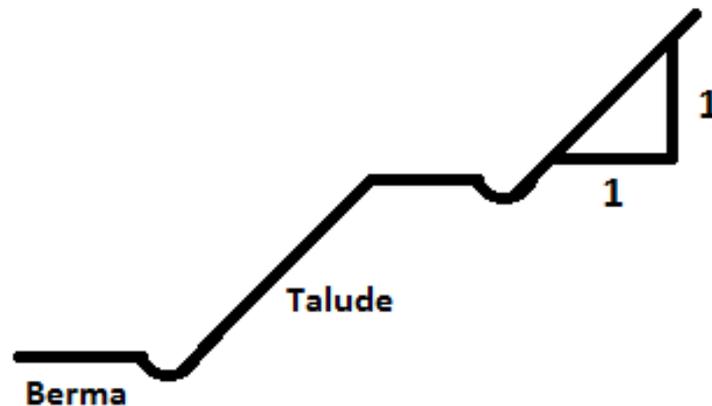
Corte esquemático de alocação das linhas de drenagem
